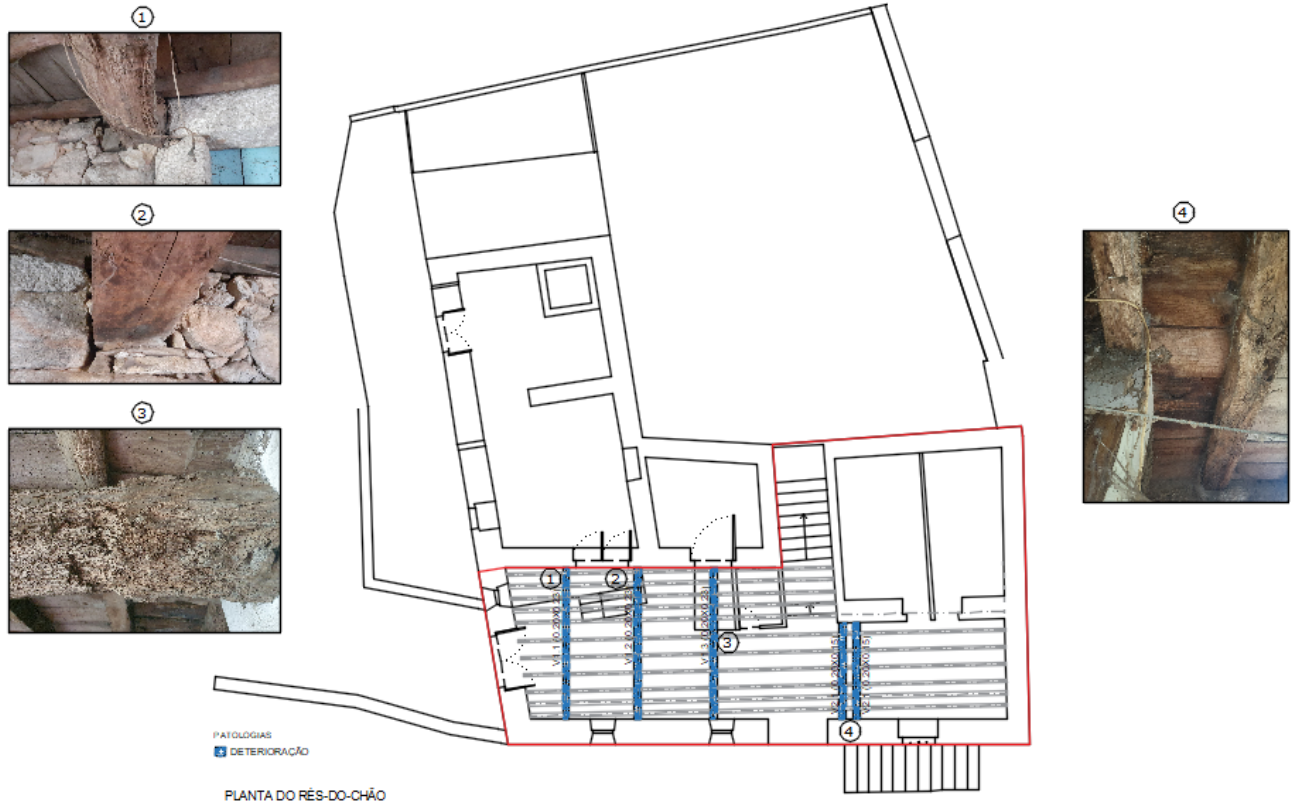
Representação das vigas deterioradas na área inspecionada – planta do teto do rés-do-chão (sem escala).
